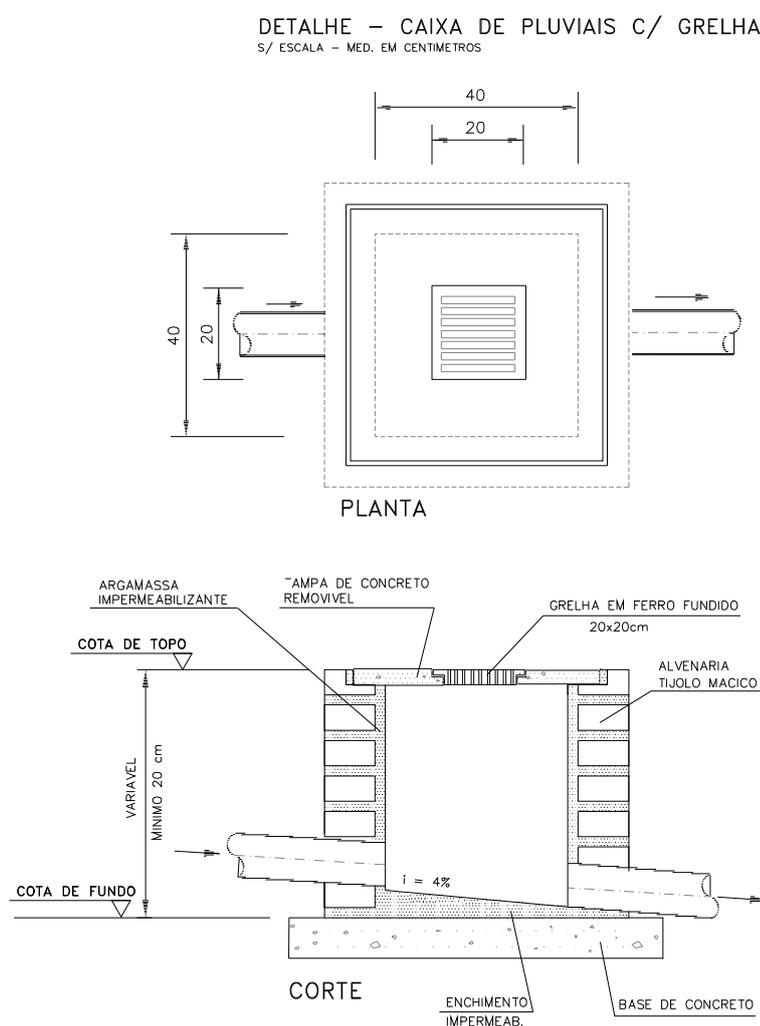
Planta e corte da caixa de inspeção de Água Pluvial
